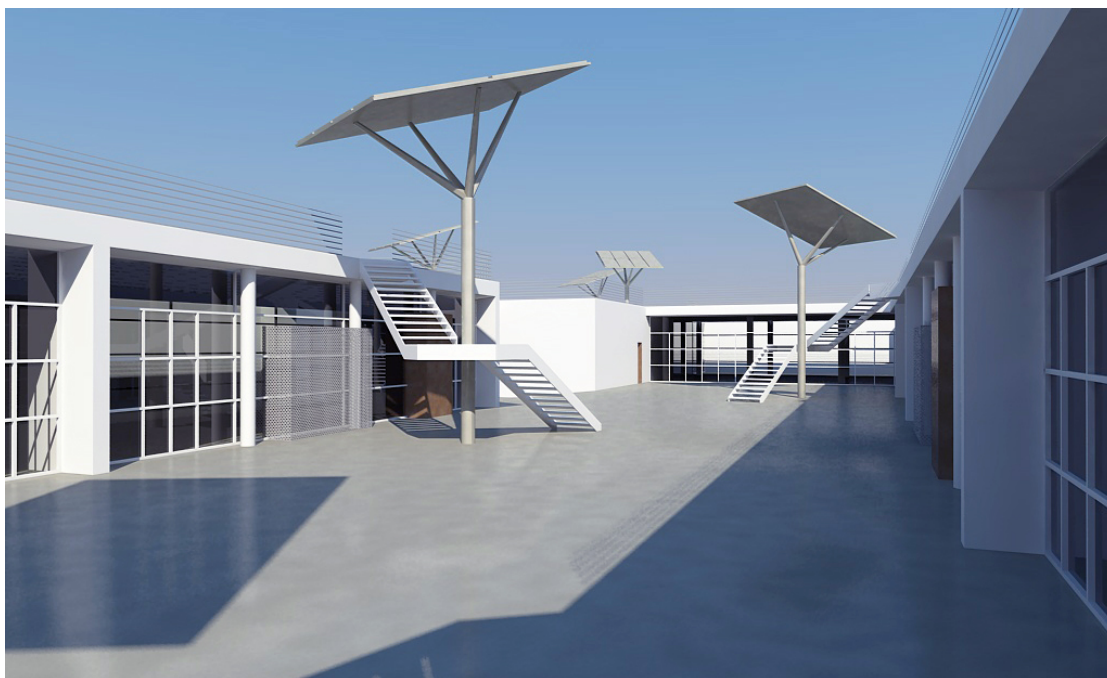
Vista verso sud della corte interna del "Piccolo Borghetto"
